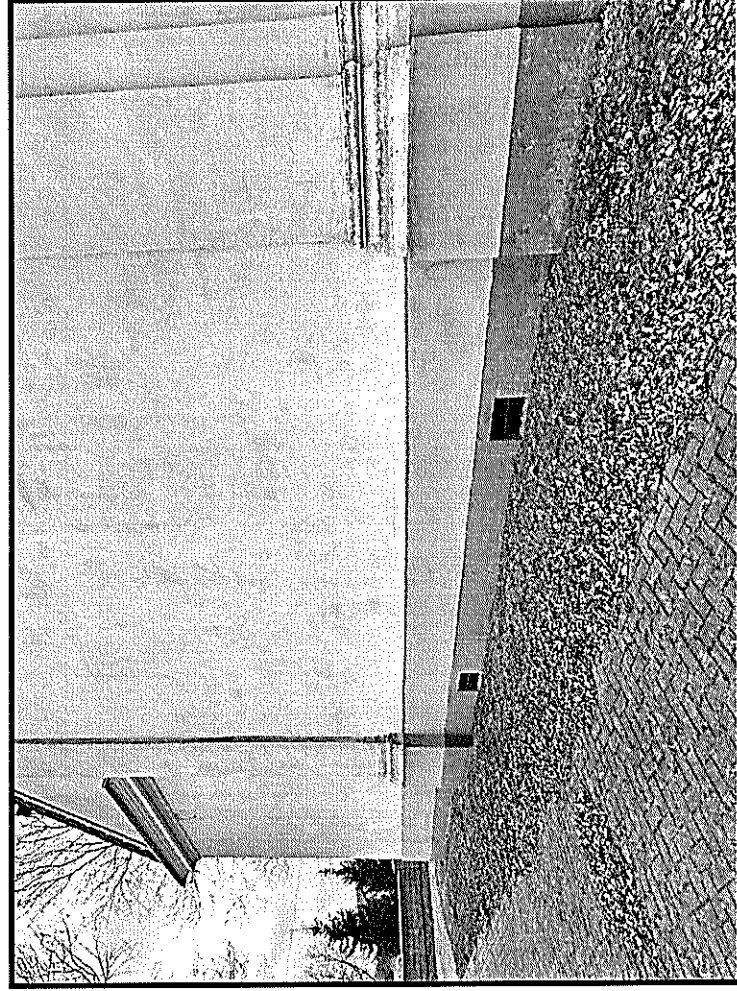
Stan zachowania elewacji wschodniej kościoła w Regnowie.
